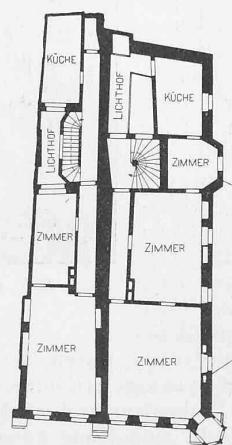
Grundriss vom Obergeschoss des alten Bestandes.
